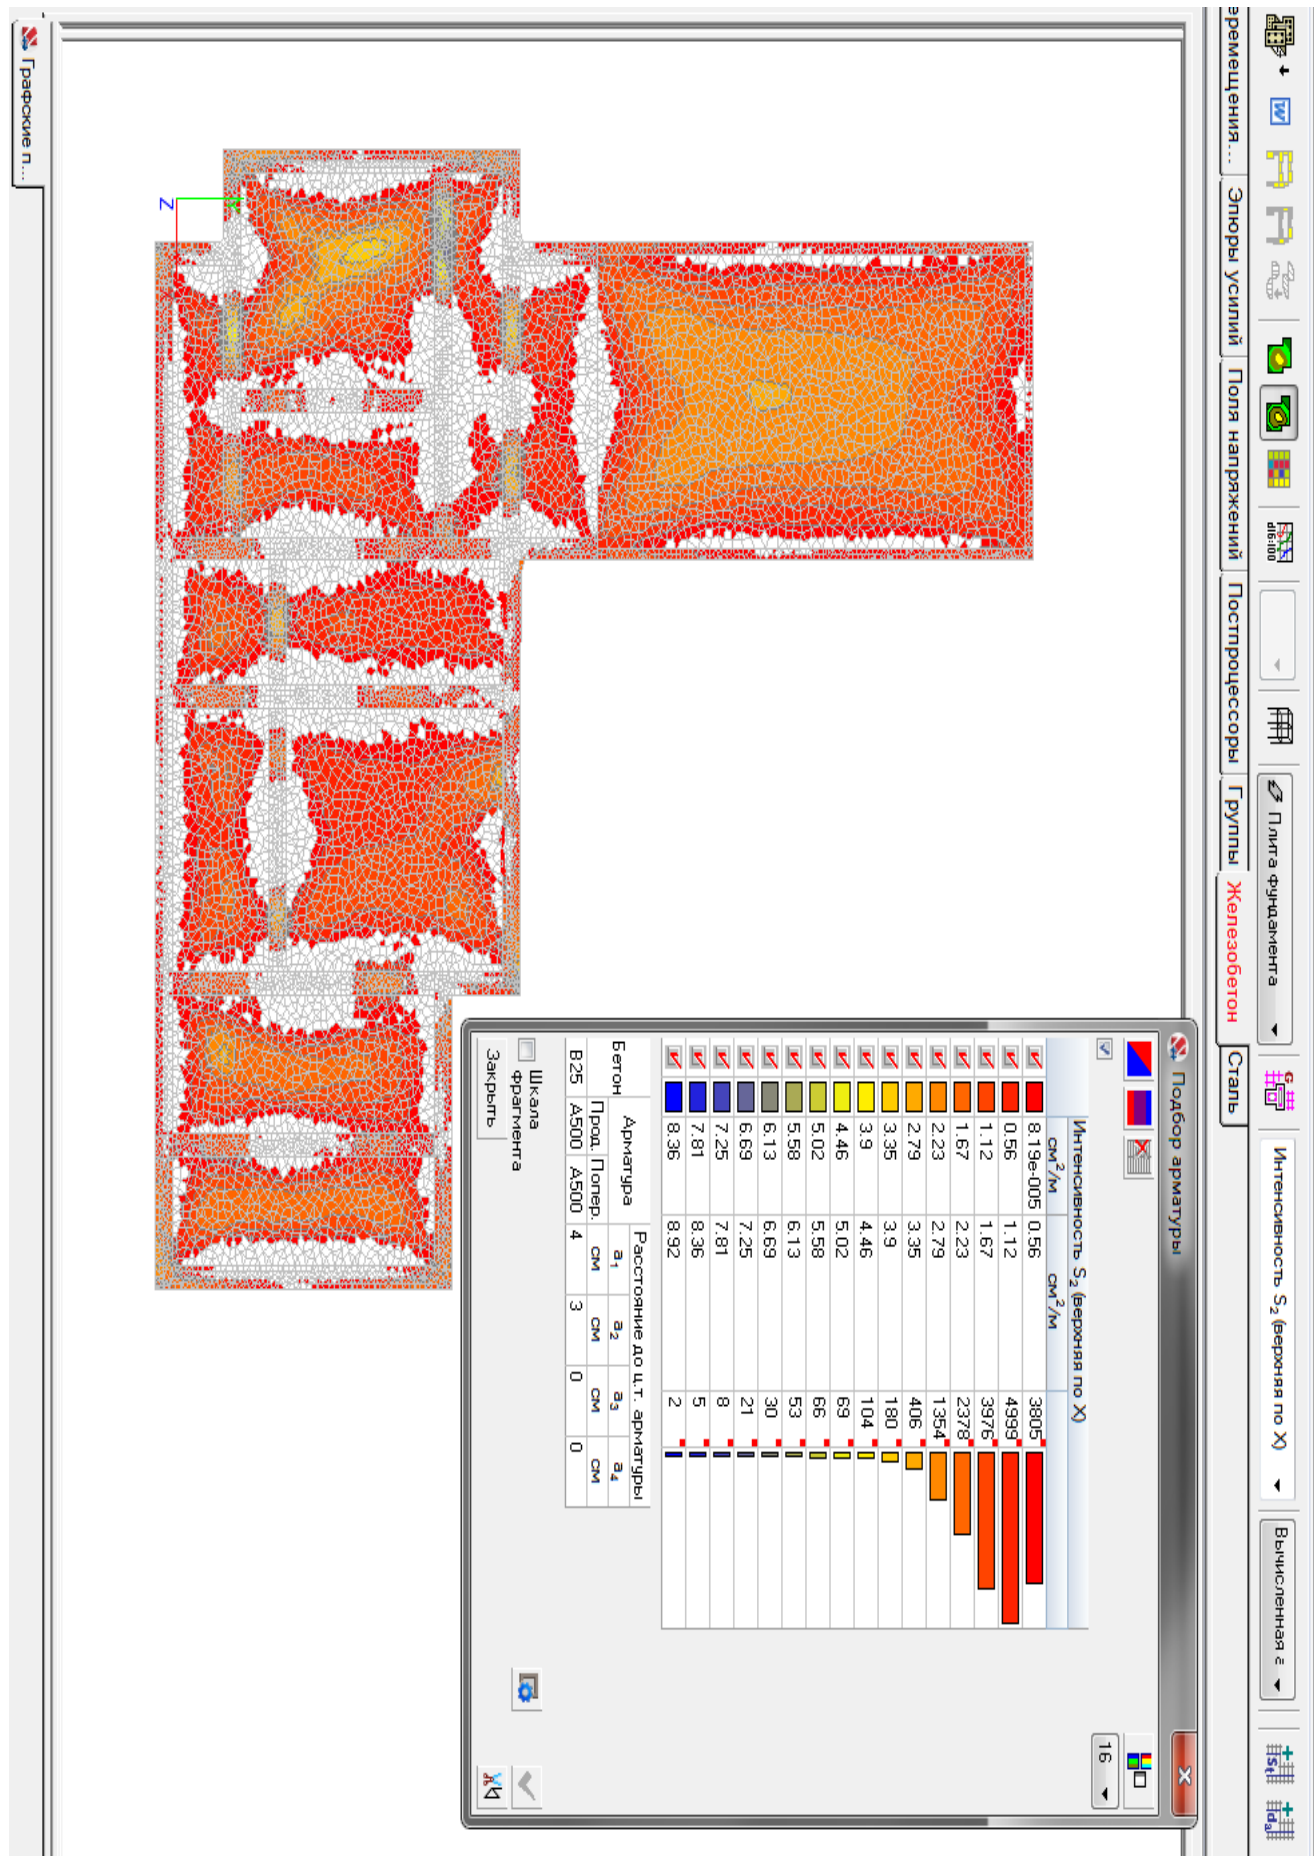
Армирование нижней зоны плиты фундамента по Y
